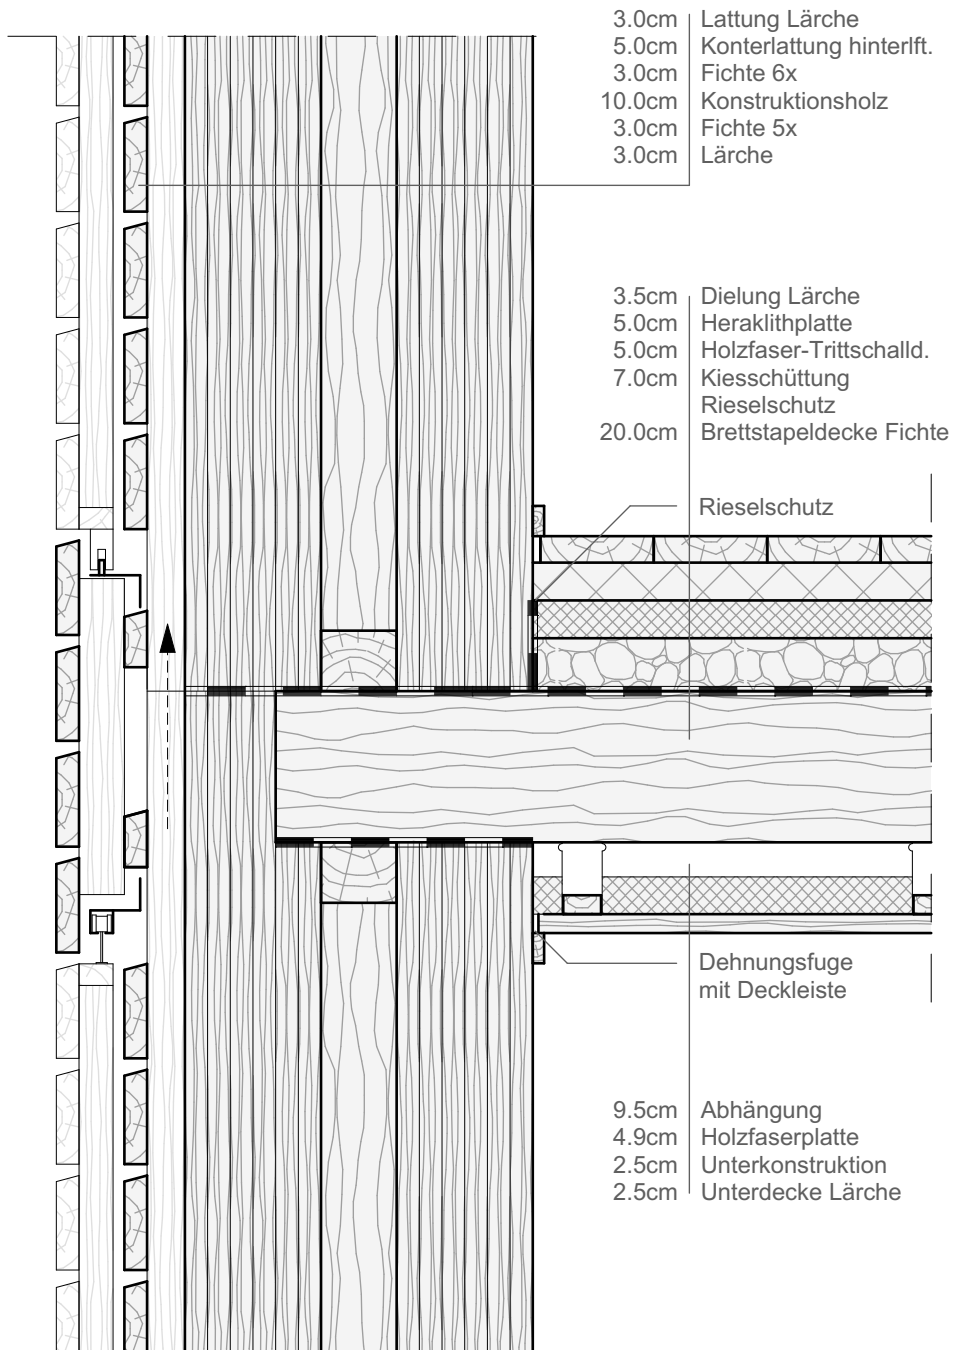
Deckenanschluss an Außenwand - Detail M 1:10
